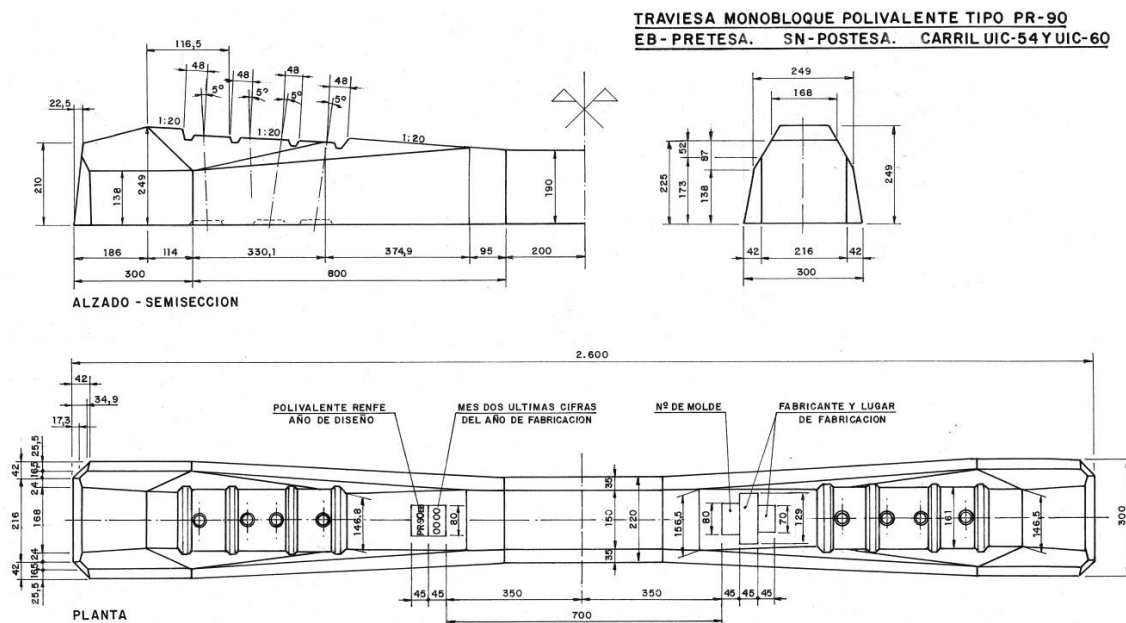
Planta, alzado y perfil de la traviesa PR-90 SN, cotas en mm. (Adif, 1997)
